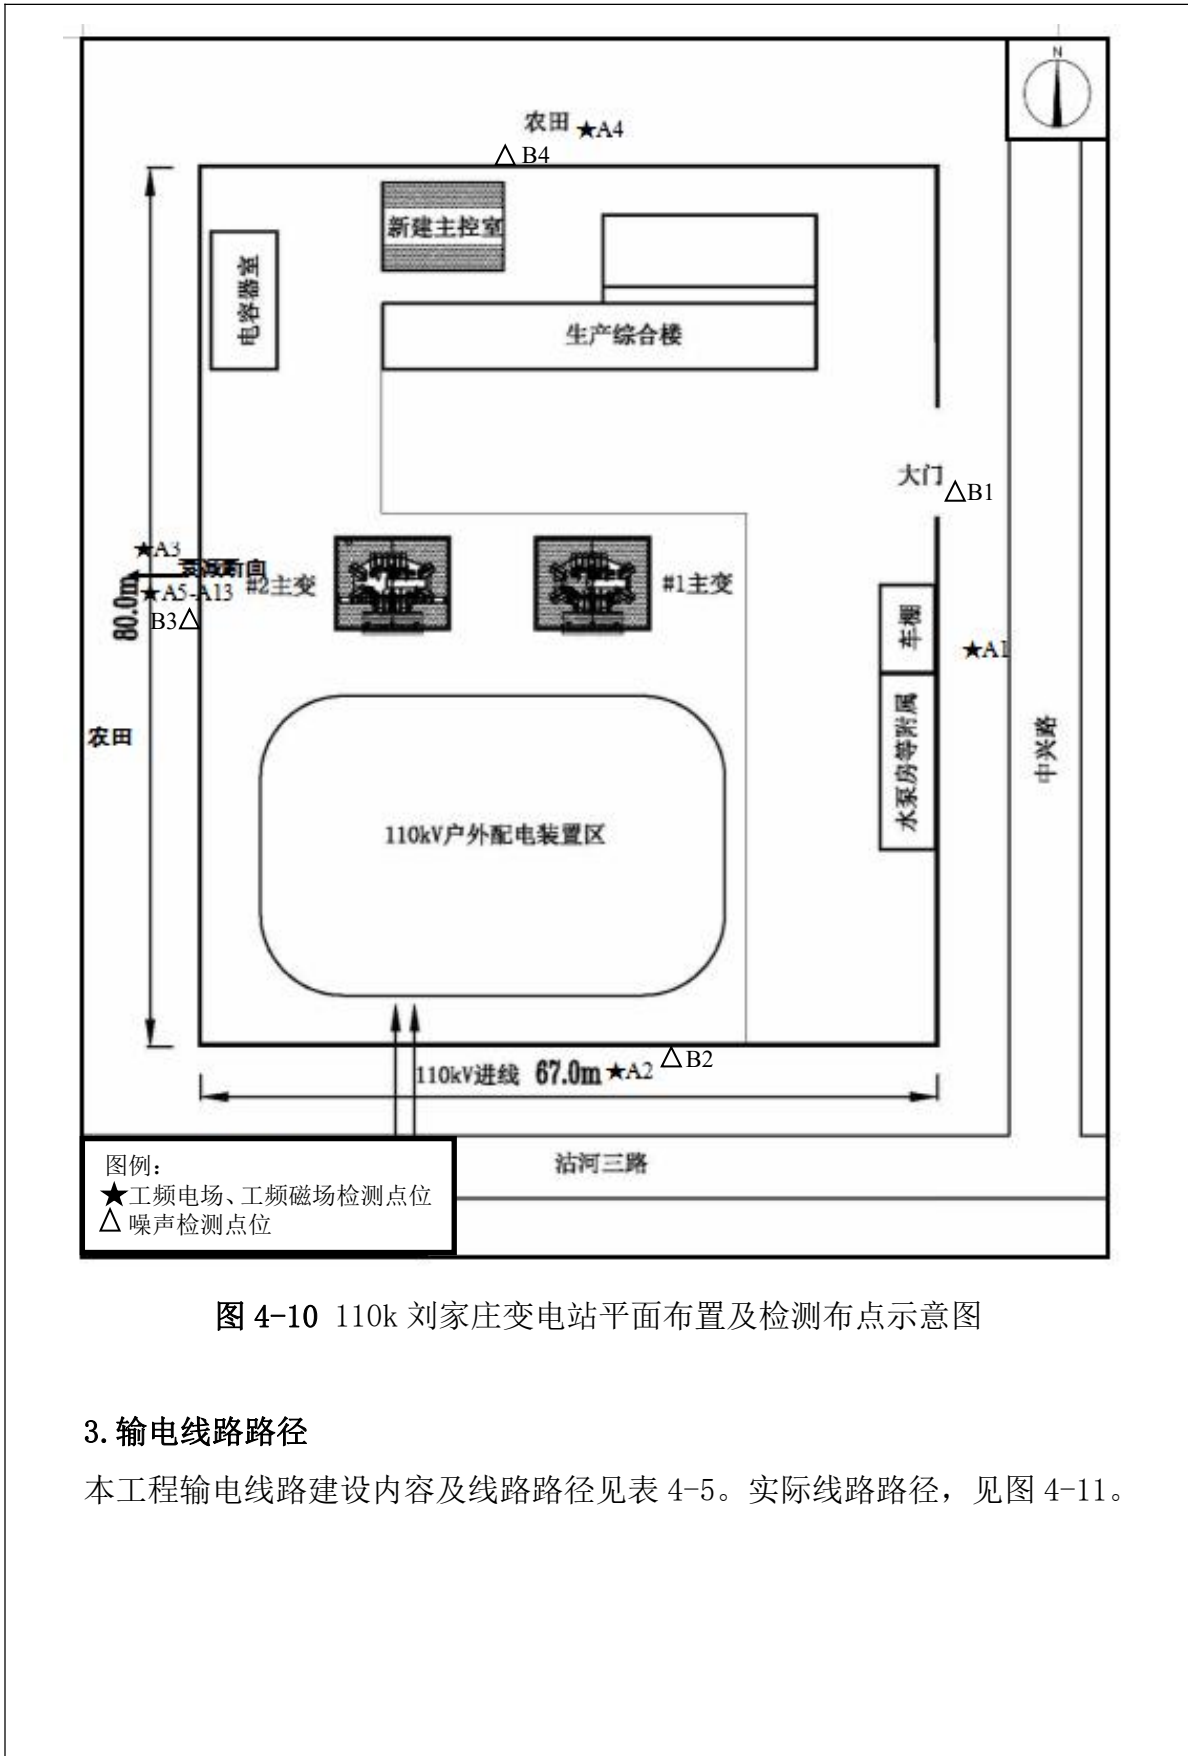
110k 刘家庄变电站平面布置及检测布点示意图
